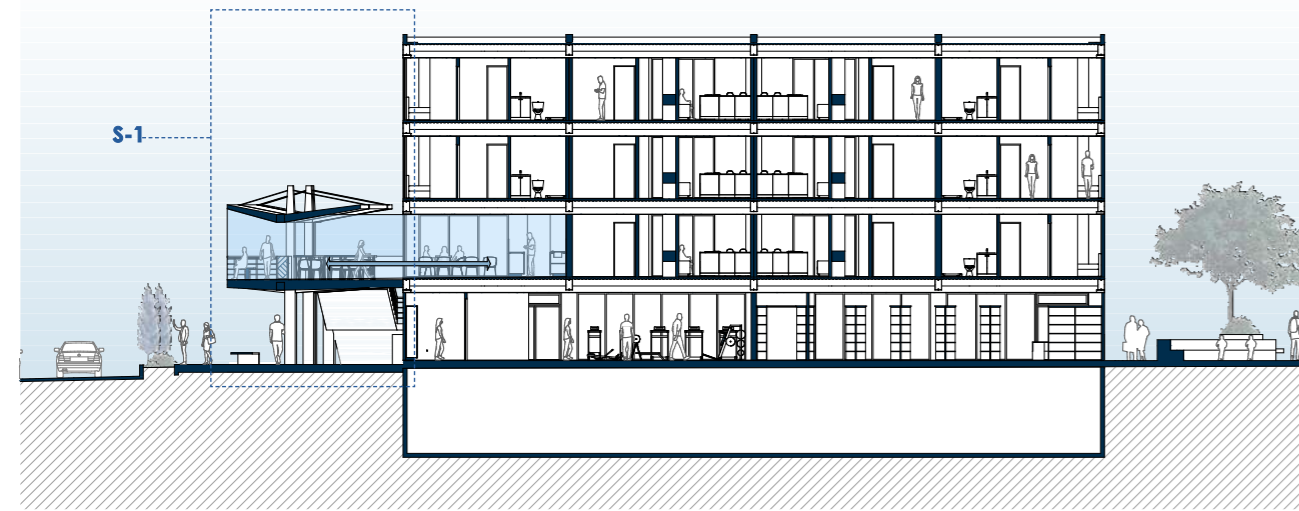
Sección Transversal Lote 1 (AMP). Fuente: Autoría propia (2026)
